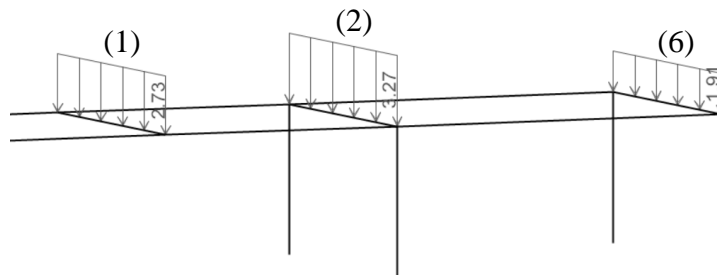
Restante Carga Permanente nas Travessas no Troço Horizontal
